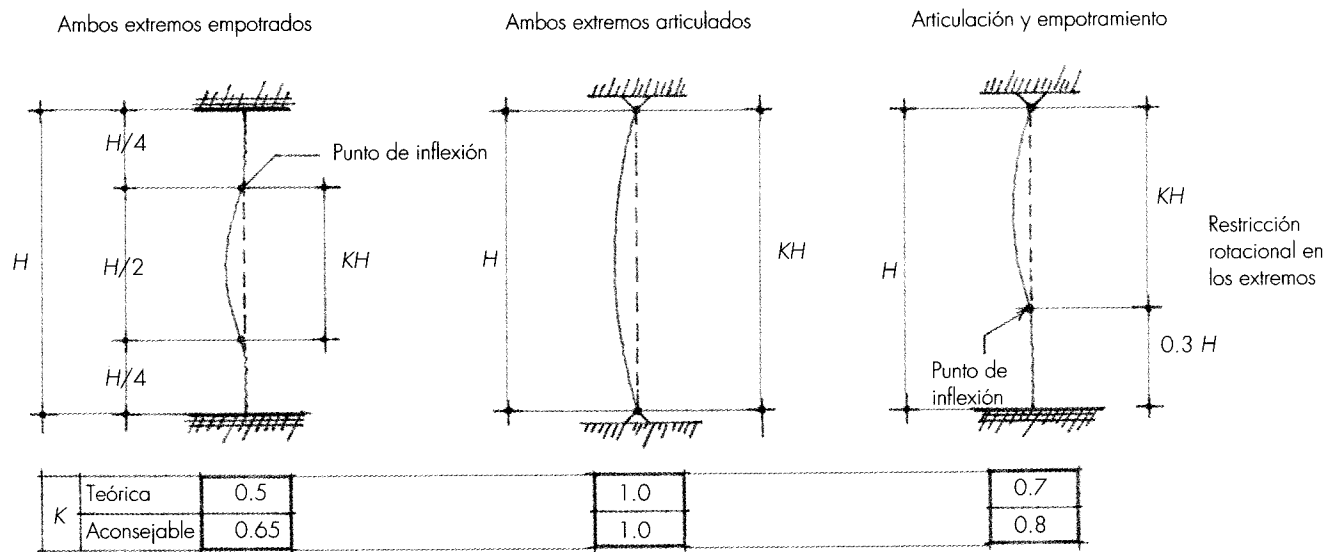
Longitud de pandeo efectiva (H_e). Columnas con desplazamiento lateral restringido.
